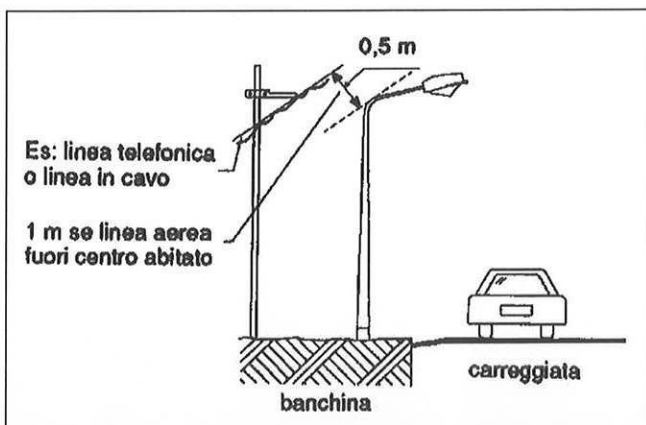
Distanza di rispetto tra apparecchi illuminanti e linee in cavo.
